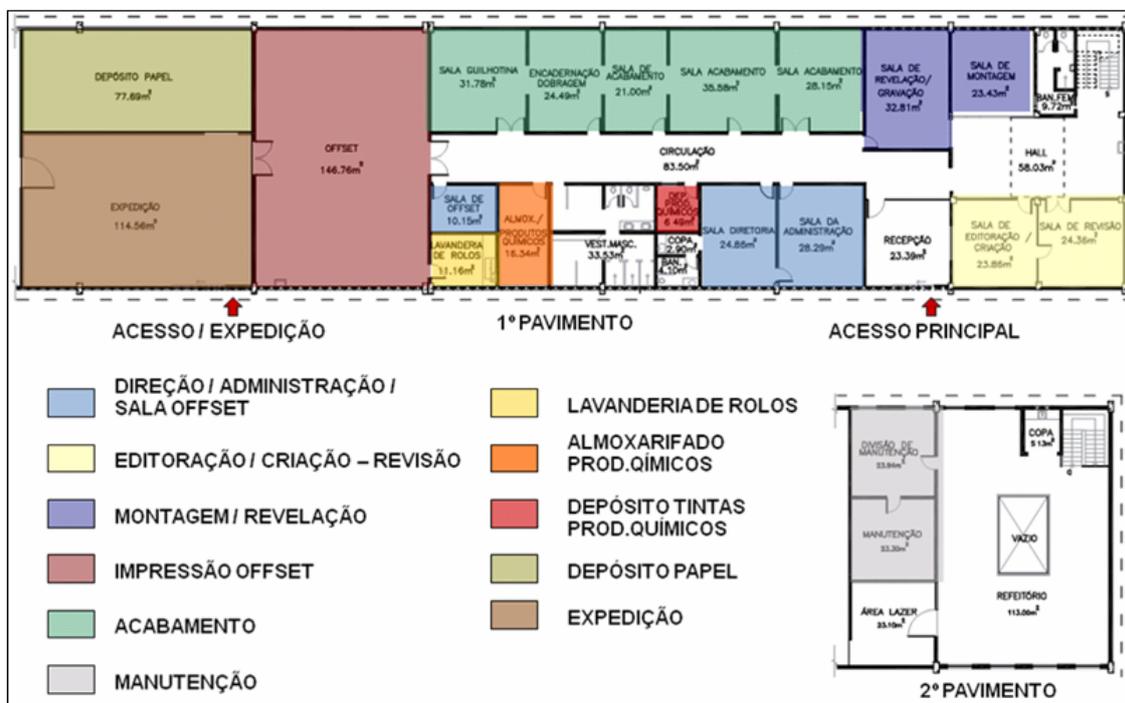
Identificação das Atividades em Planta Baixa
